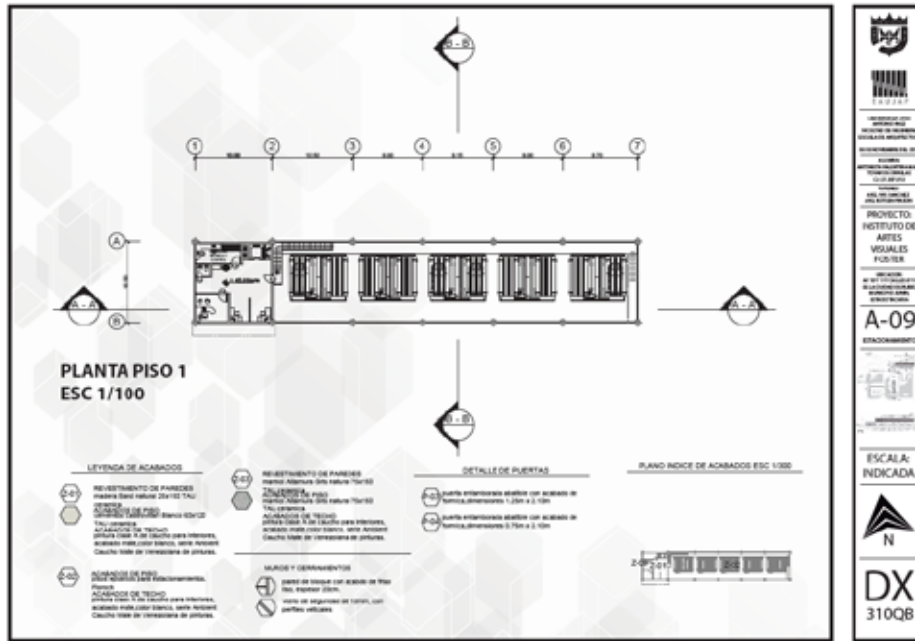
Plano de Planta Nivel 1. La autora (2020)
